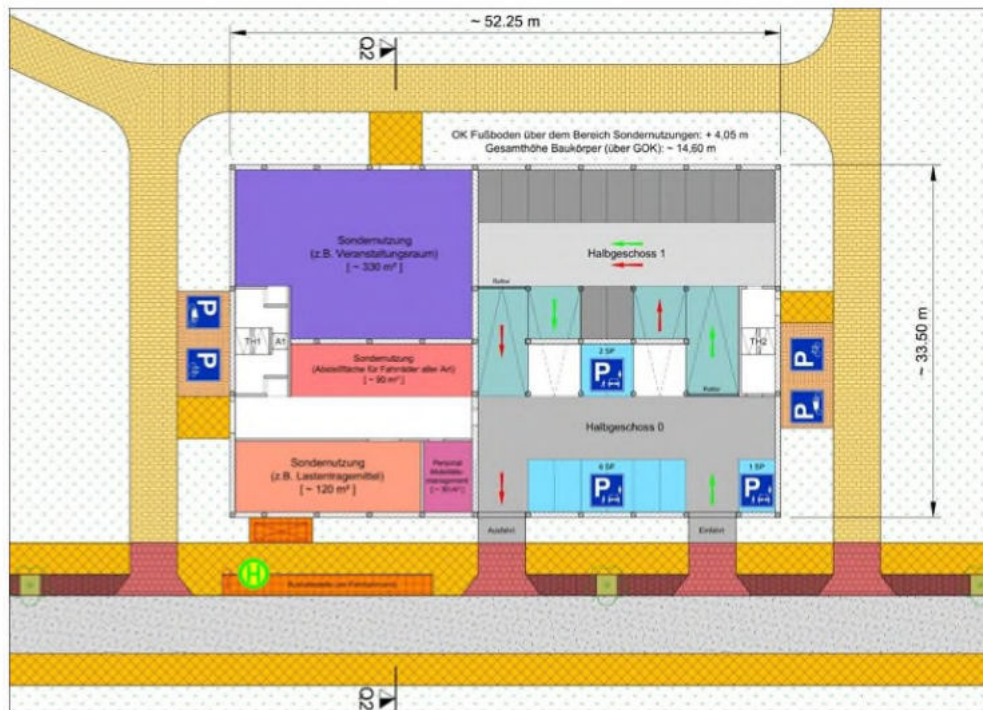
Planskizze des Erdgeschosses einer Bewohnersammelgarage mit Mobilitätszentrale
